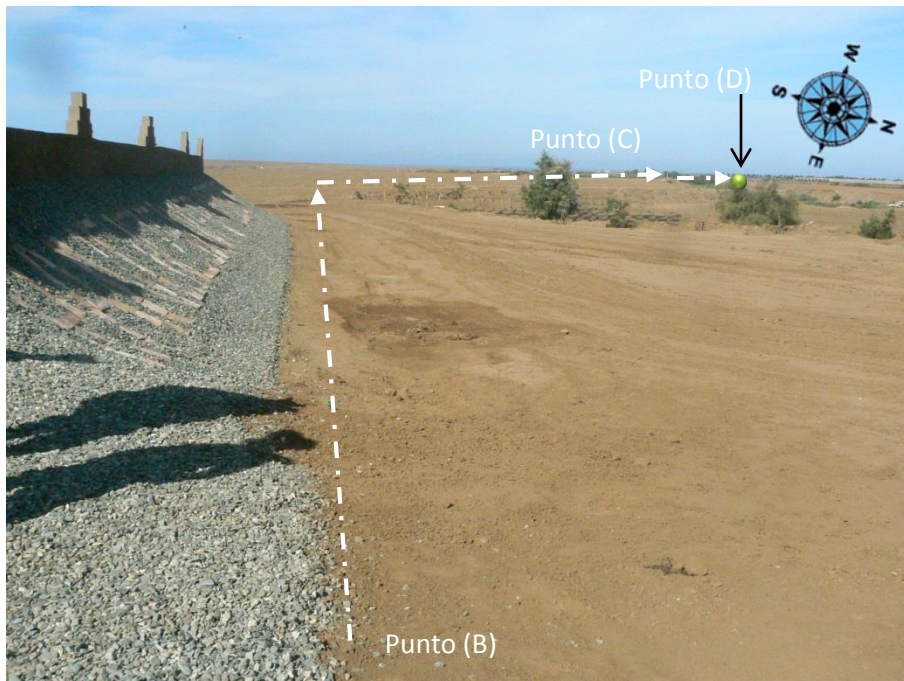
Conducción de la Sección I de la tubería dentro del predio del proyecto tramo (B)-(C) y (D).
